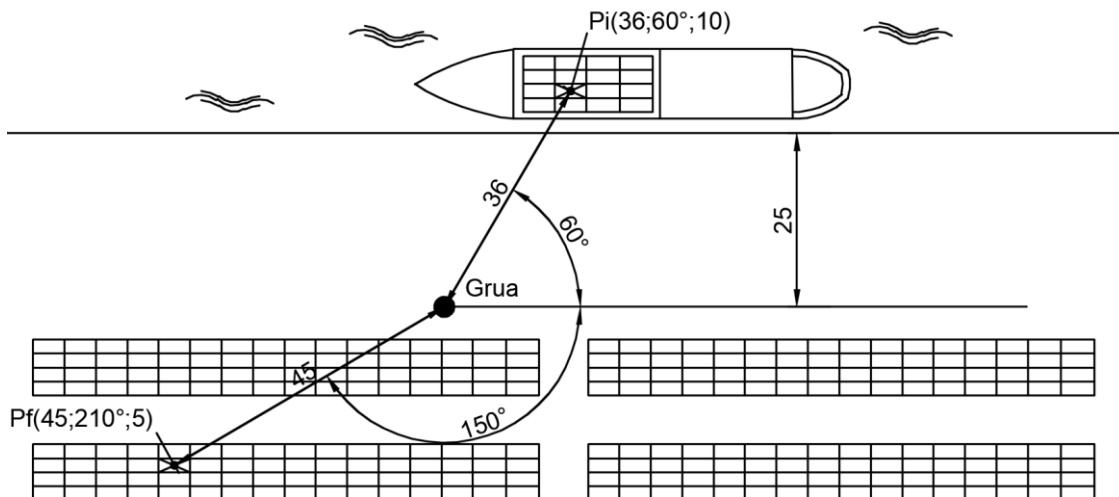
Vista en planta de la operación que debe realizar la grúa torre.
